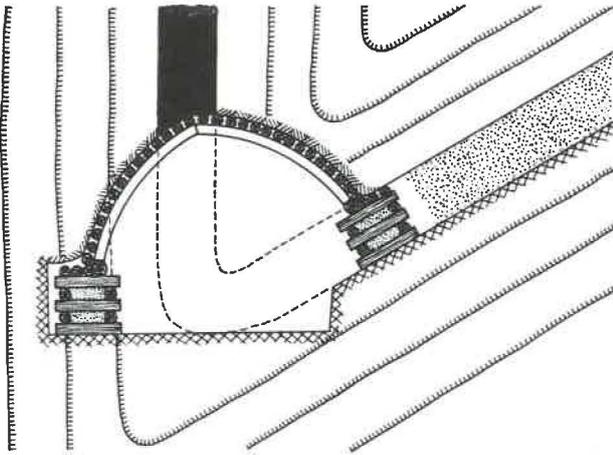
Voie de base en crochon de pied : soutènement définitif en cadres articulés sur piles de bois.
